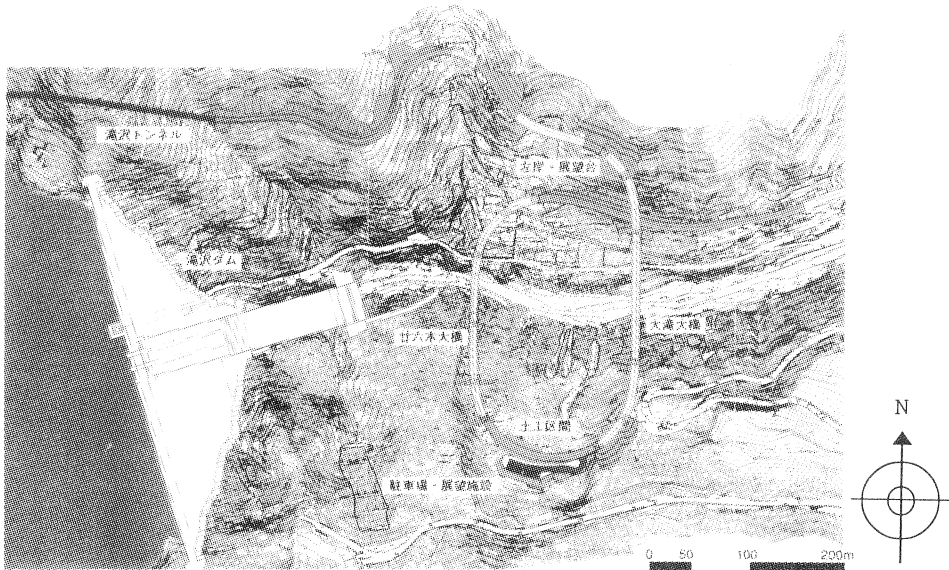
滝沢ダム(施工中)と廿六木大橋・大滝大橋の配置図
